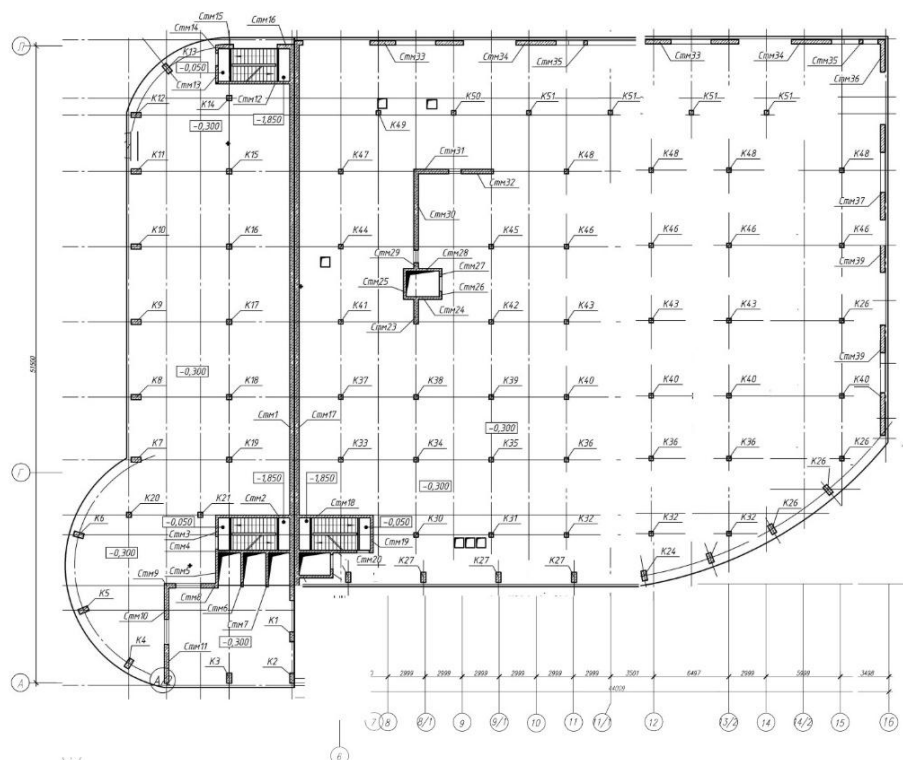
Схема нагрузок на фундаментную плиту на отметке минус 0,550
